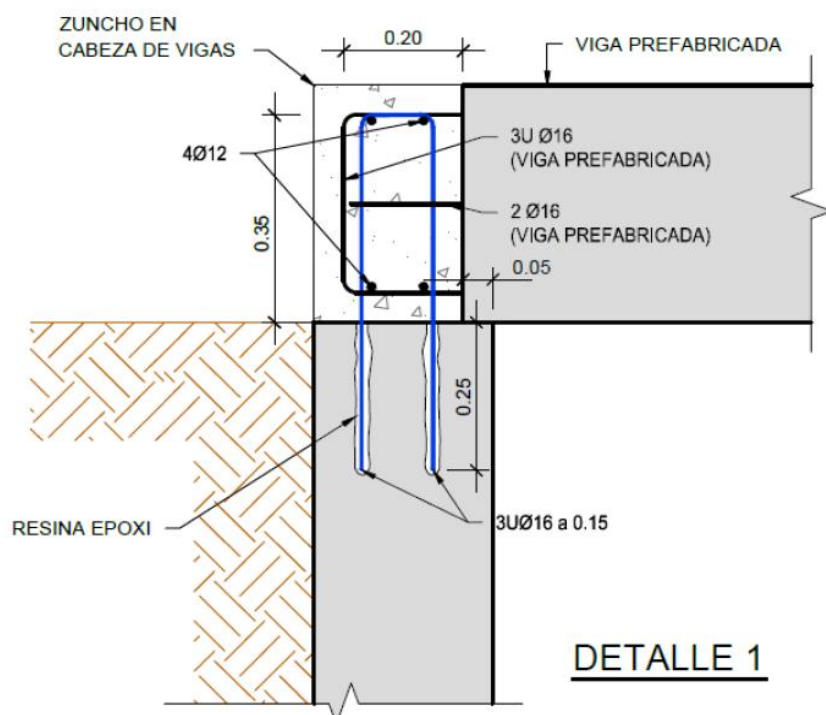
Sección unión viga arrostramiento con muro. Canal Calzas Anchas. Utrera (Sevilla). [90]
